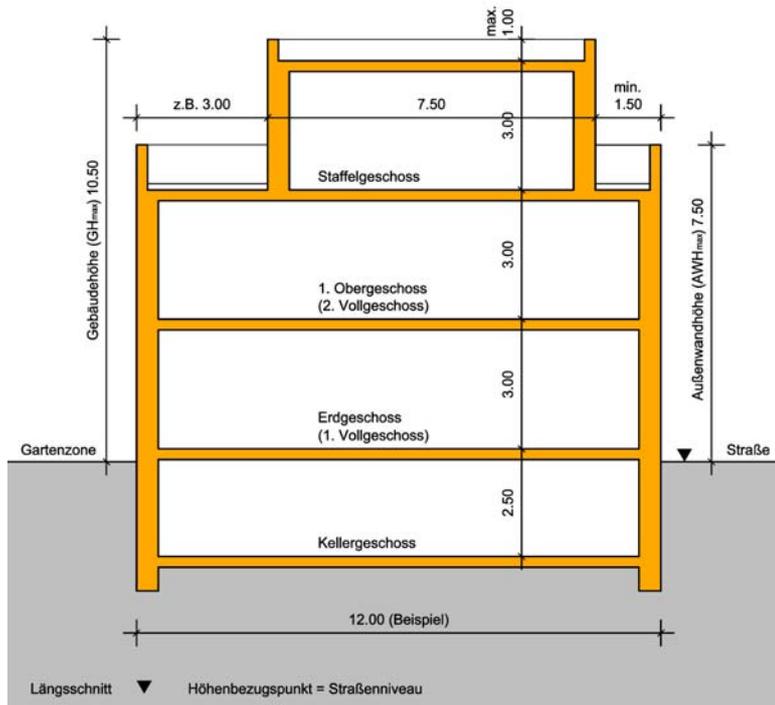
Schema-Längsschnitt zur Verdeutlichung der zulässigen Höhen bei Flachdach und zwei Vollgeschossen
